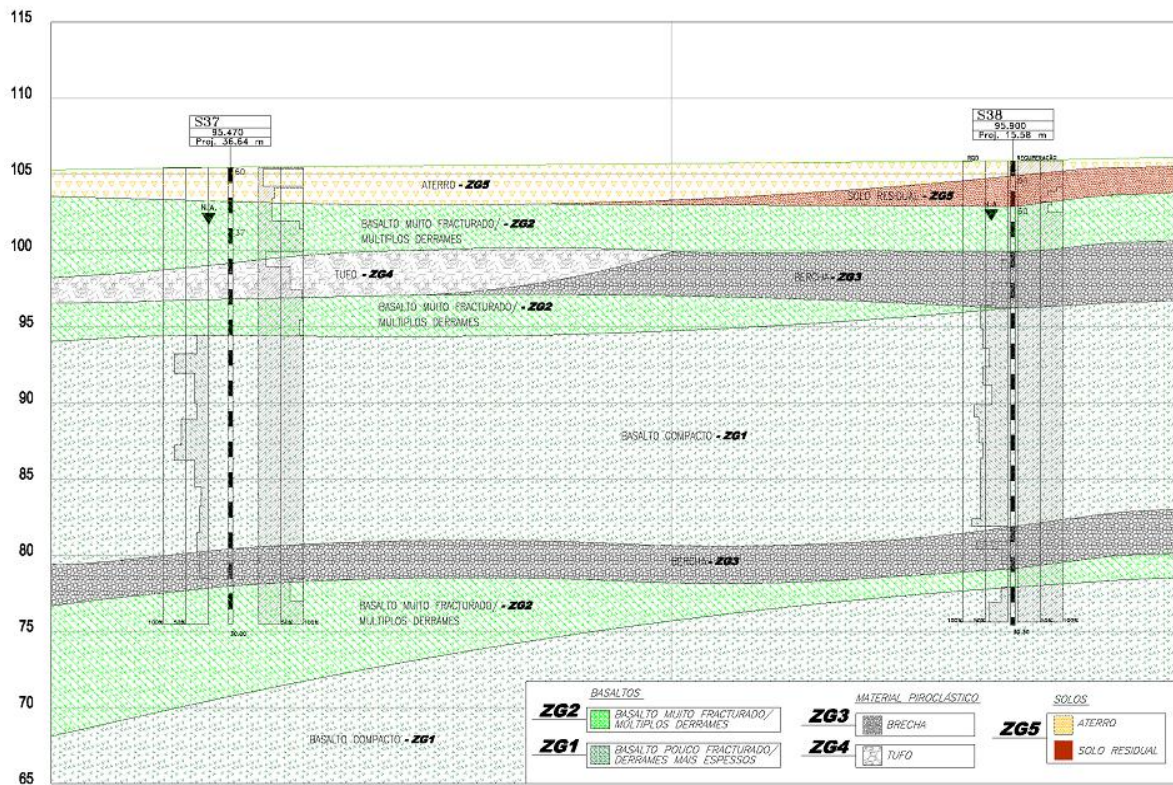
Perfil geológico-geotécnico B-B, baseada nas sondagens S37 e S38 (adaptado NE ACE, 2008).
